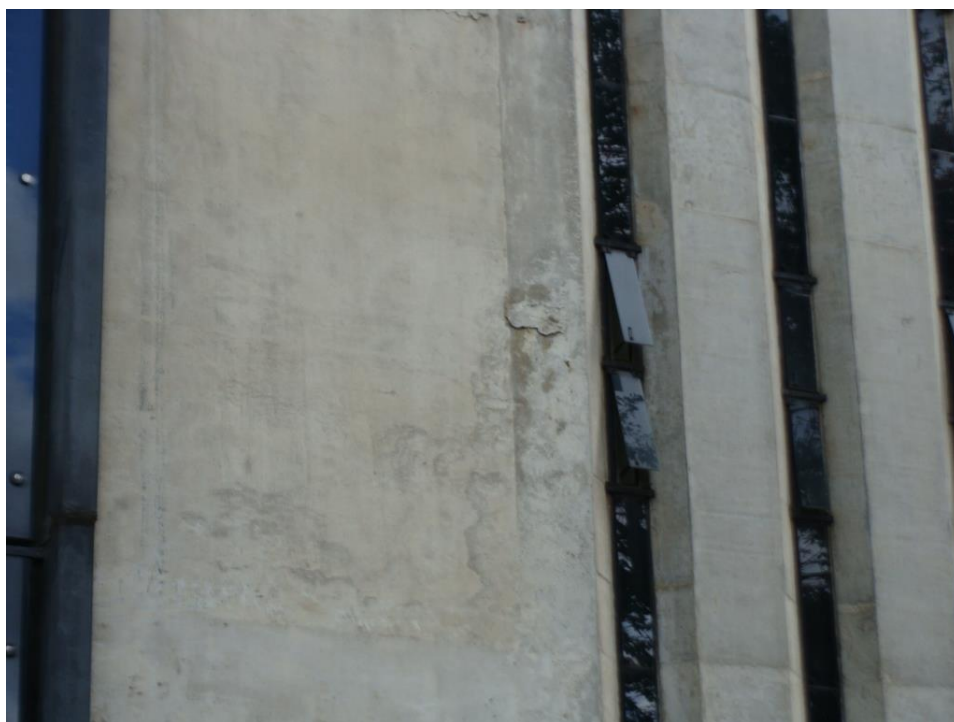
Armadura exposta pilar P10 (02/03/2021)
